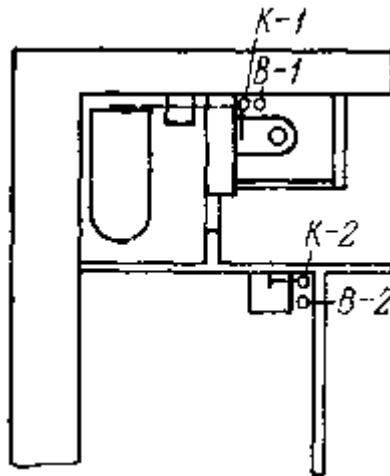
План помещений санитарно-кухонного узла с указанием сети водопровода и канализации
